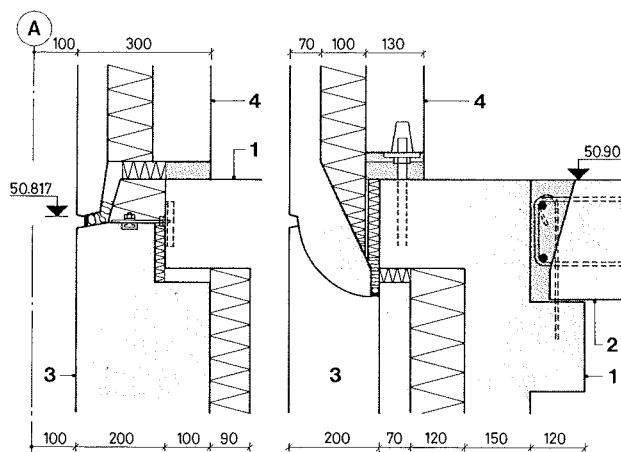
Samlingsdetaljer, 1:15. Til venstre vises i lodret snit samlingen mellem facadeelementerne og den påsatte søjle. I 2-etagers facadeelement, 2 langspænddæk, 3 søjleelement, 4 facade i etage 3. Søjlen fastholdes med et stålbeslag mellem 2 halffænsenskiner. Til højre vises fugeløsningen mellem de 2 facadeelementer i et lodret snit mellem 2 facadesøjler.
